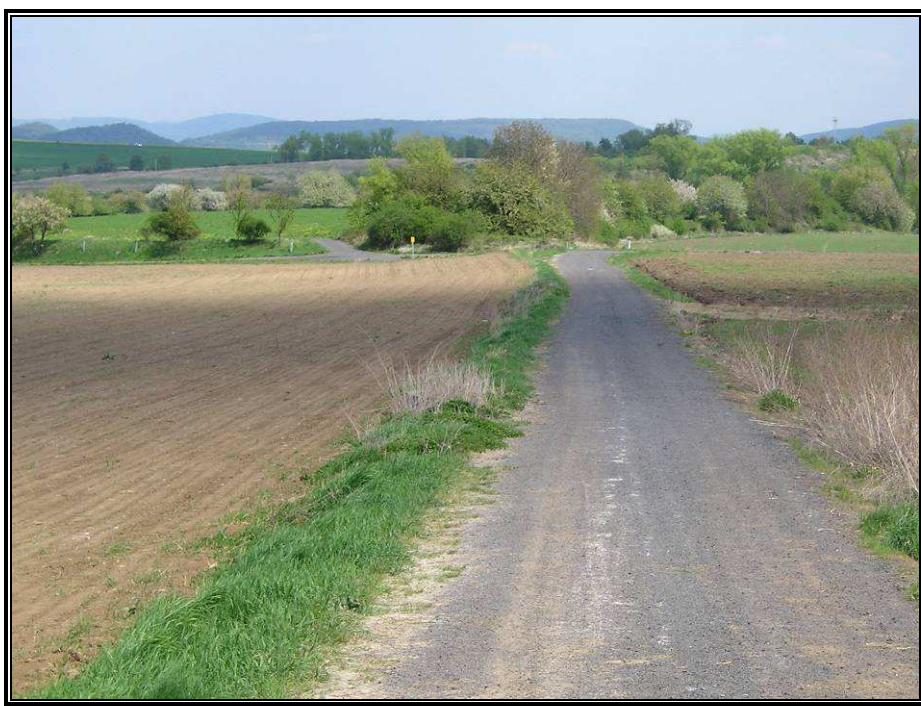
Bžany - cesta VPC 1 v současném stavu, foto Halamová M., dne 5. 10. 2011
